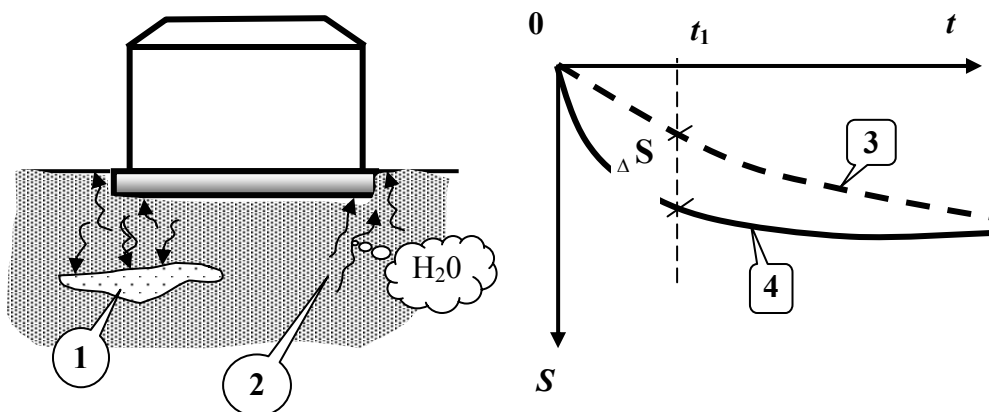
Неравномерные осадки уплотнения при неравномерной консолидации грунтов: 1 – песчаная прослойка; 2 – медленно деформирующееся основание; 3 – осадка медленно деформирующегося основания; 4 – осадка при наличии песчаной прослойки
